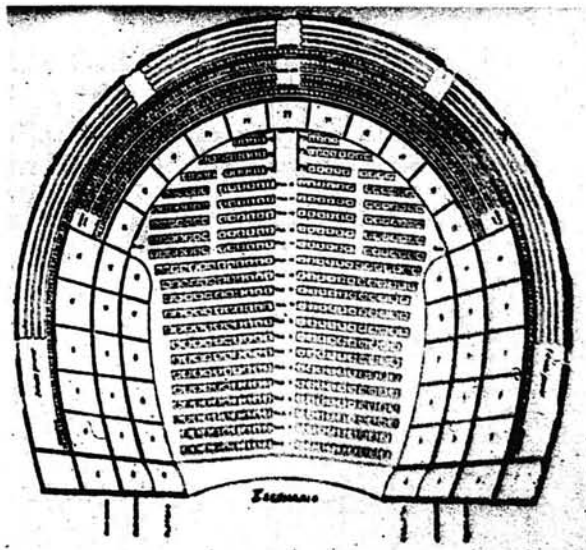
Planta del teatro Lope de Vega (Valladolid).
